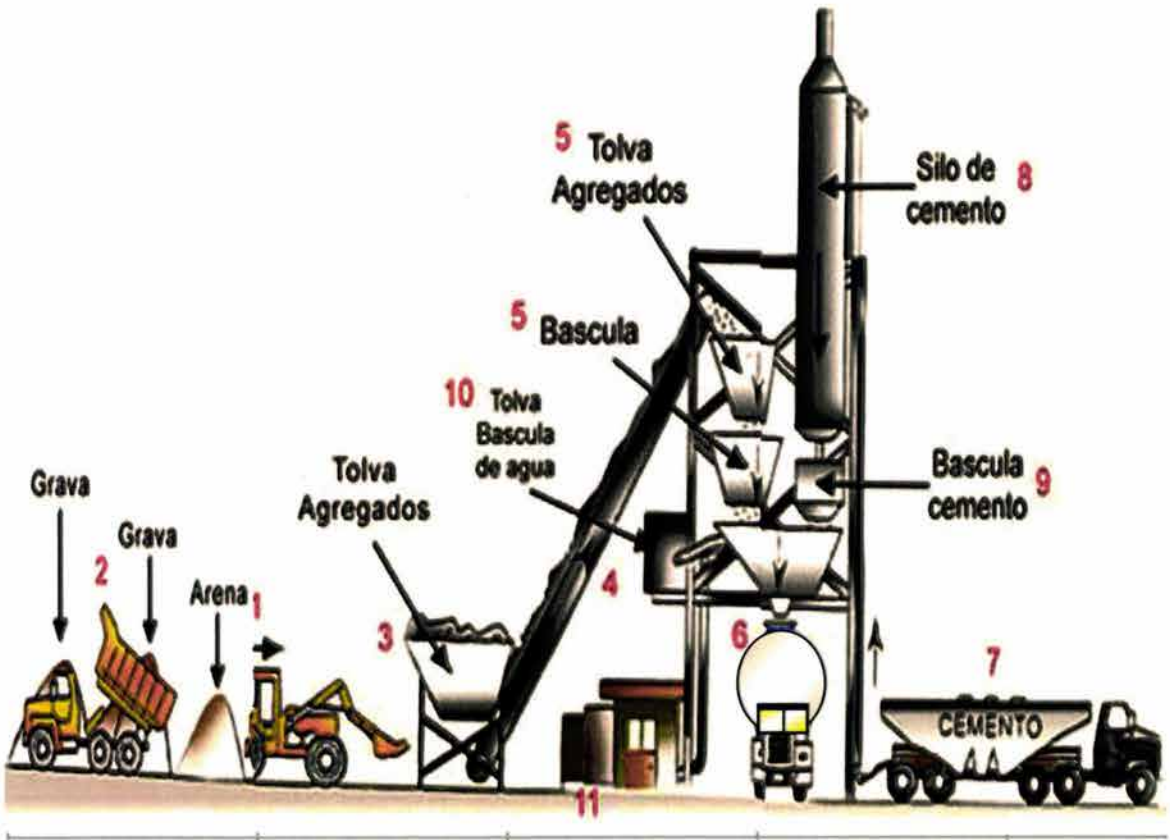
que muestra elementos principales en una planta para producir concreto premezclado
